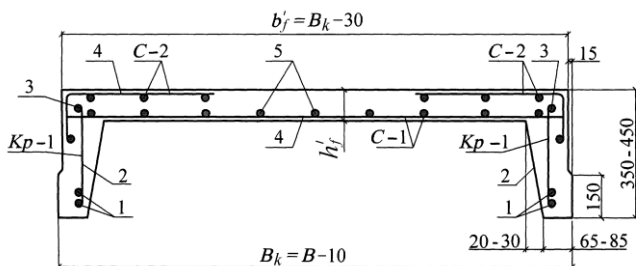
Схема расположения арматуры в поперечном сечении
